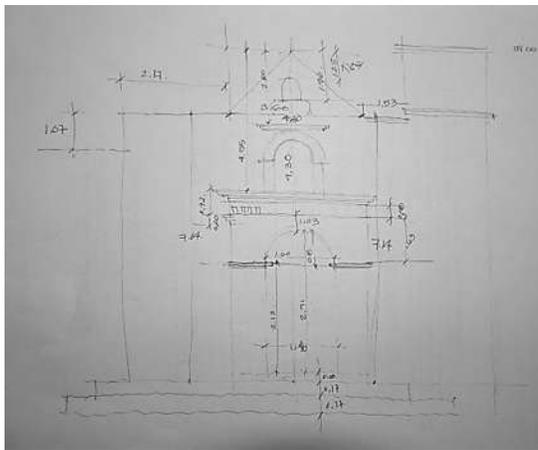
Dibujo de fachada, capilla San Juan Bautista. Fuente: elaboro Arq. Ma Elena Cortes
